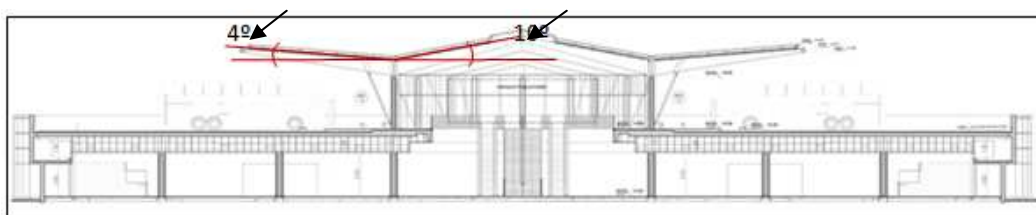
Detalle de la cubierta y su inclinación en corte, las flechas indican la zona donde se ubican los paneles
